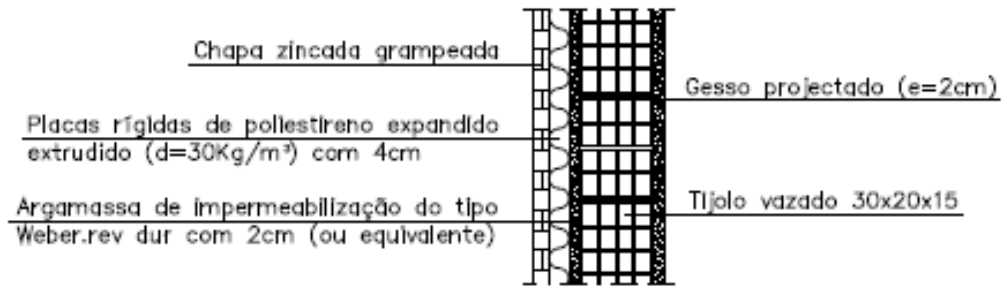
Pormenor construtivo da parede de fachada frontal do piso recuado (Projeto de CT)
